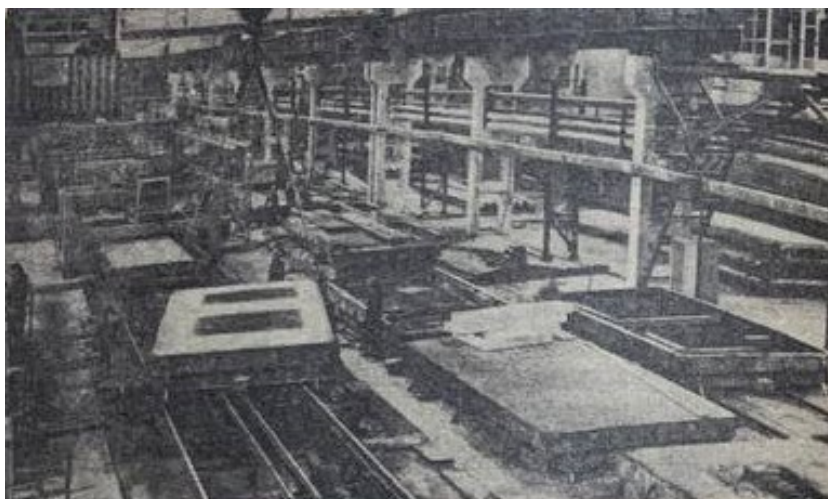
Конвейерная линия по изготовлению стеновых панелей из шунгизитобетона на комбинате строительных конструкций №1, г. Петрозаводск [3]
